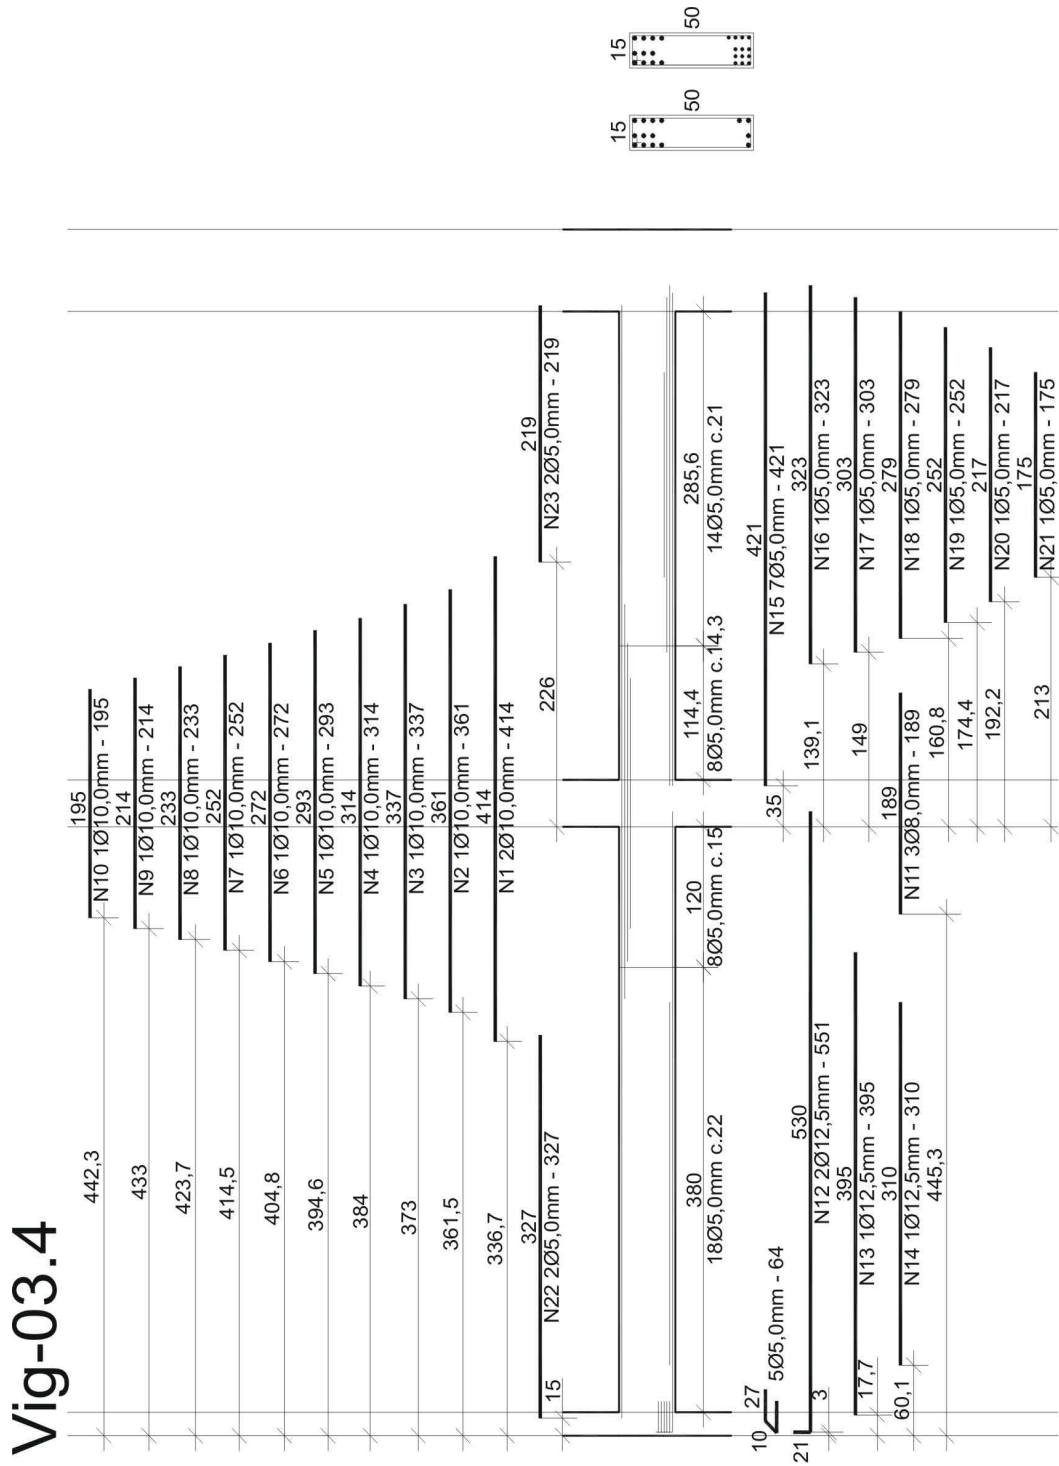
Detalhamento Viga 03.4, realizado pelo VigaCalc.
